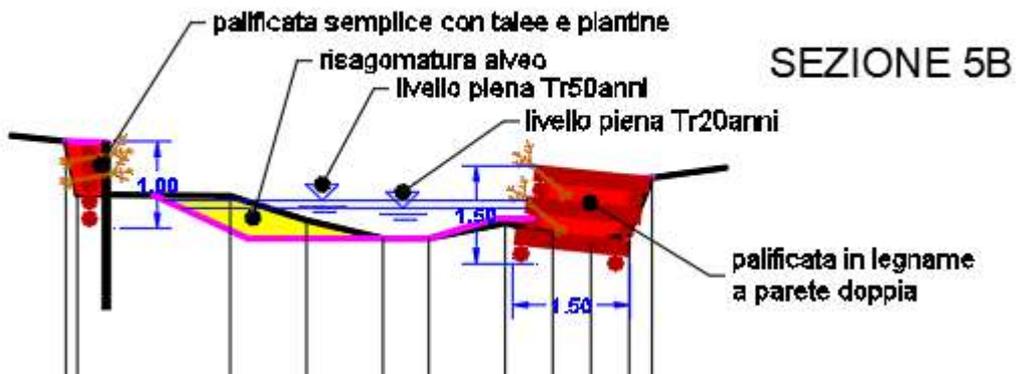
Sezione tipo alveo. (rappresentazione non in scala)
